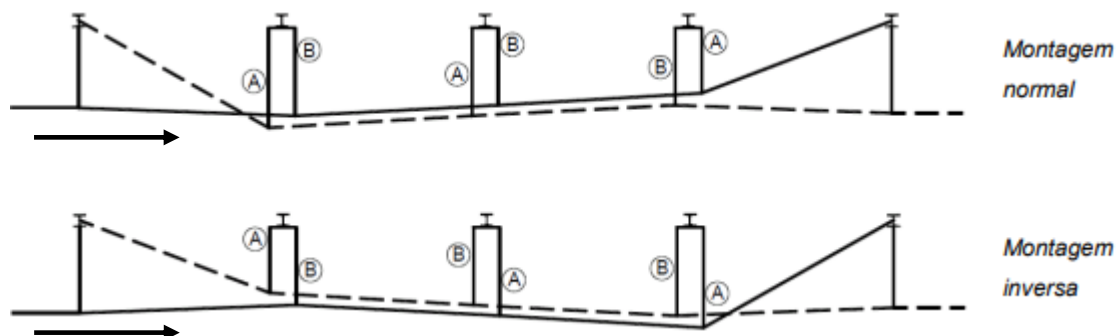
Zona comum e seccionamento de lâmina de ar – representação em planta
